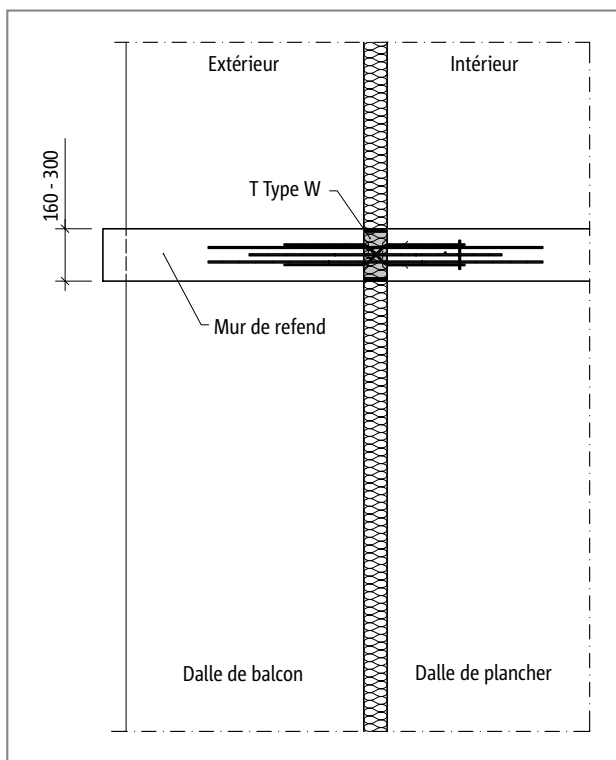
Schöck Isokorb® T Type W : Plan de base ; Construction de balcon avec murs de refend porteurs isolés thermiquement
